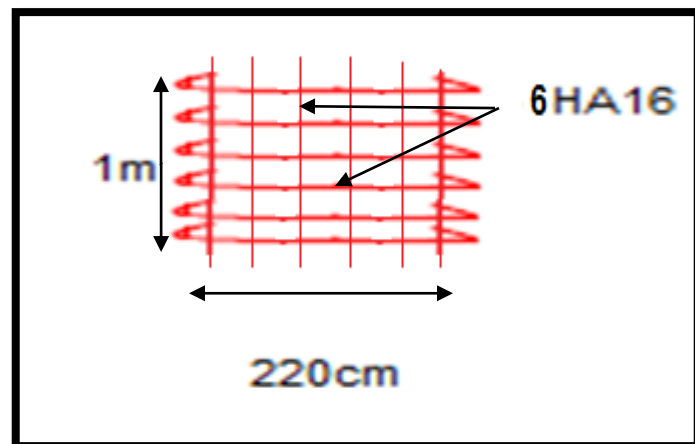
Schéma de ferrailage de la semelle filante sous viol.
